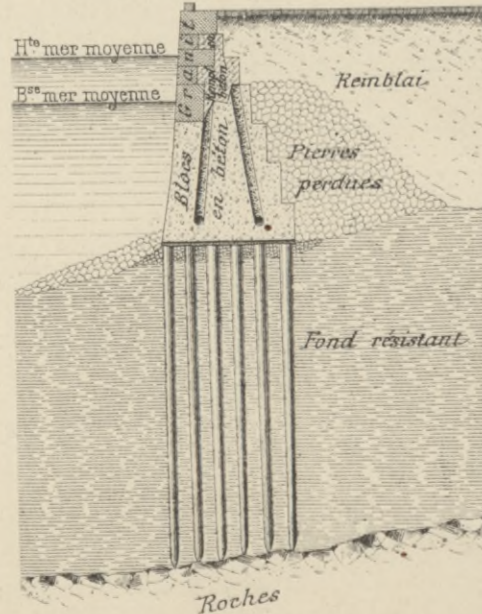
Elévation et Coupe longitudinale du mur profil type D.
